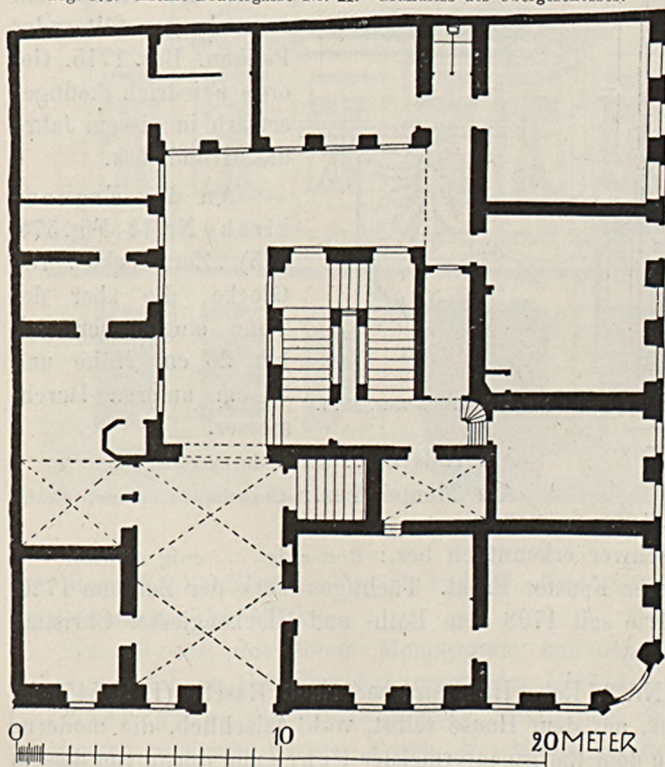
Kleine Brüdergasse Nr. 21. Grundriss des Erdgeschosses.
